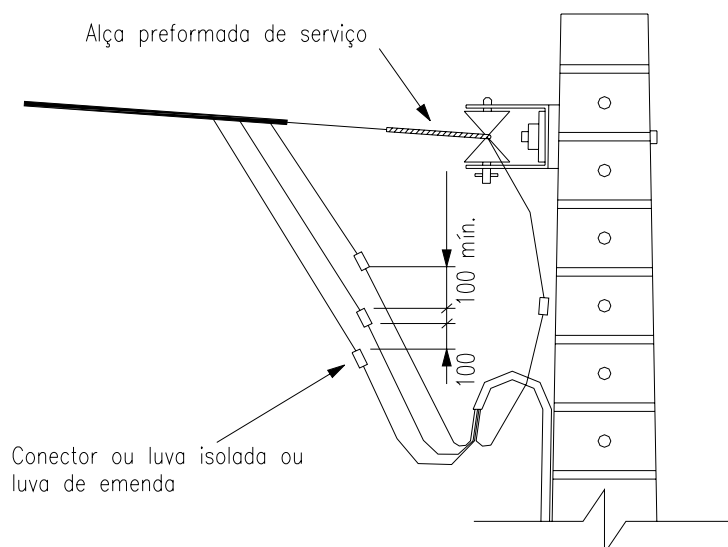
e) Ramal de ligação ao ramal de entrada (dimensões em mm)
